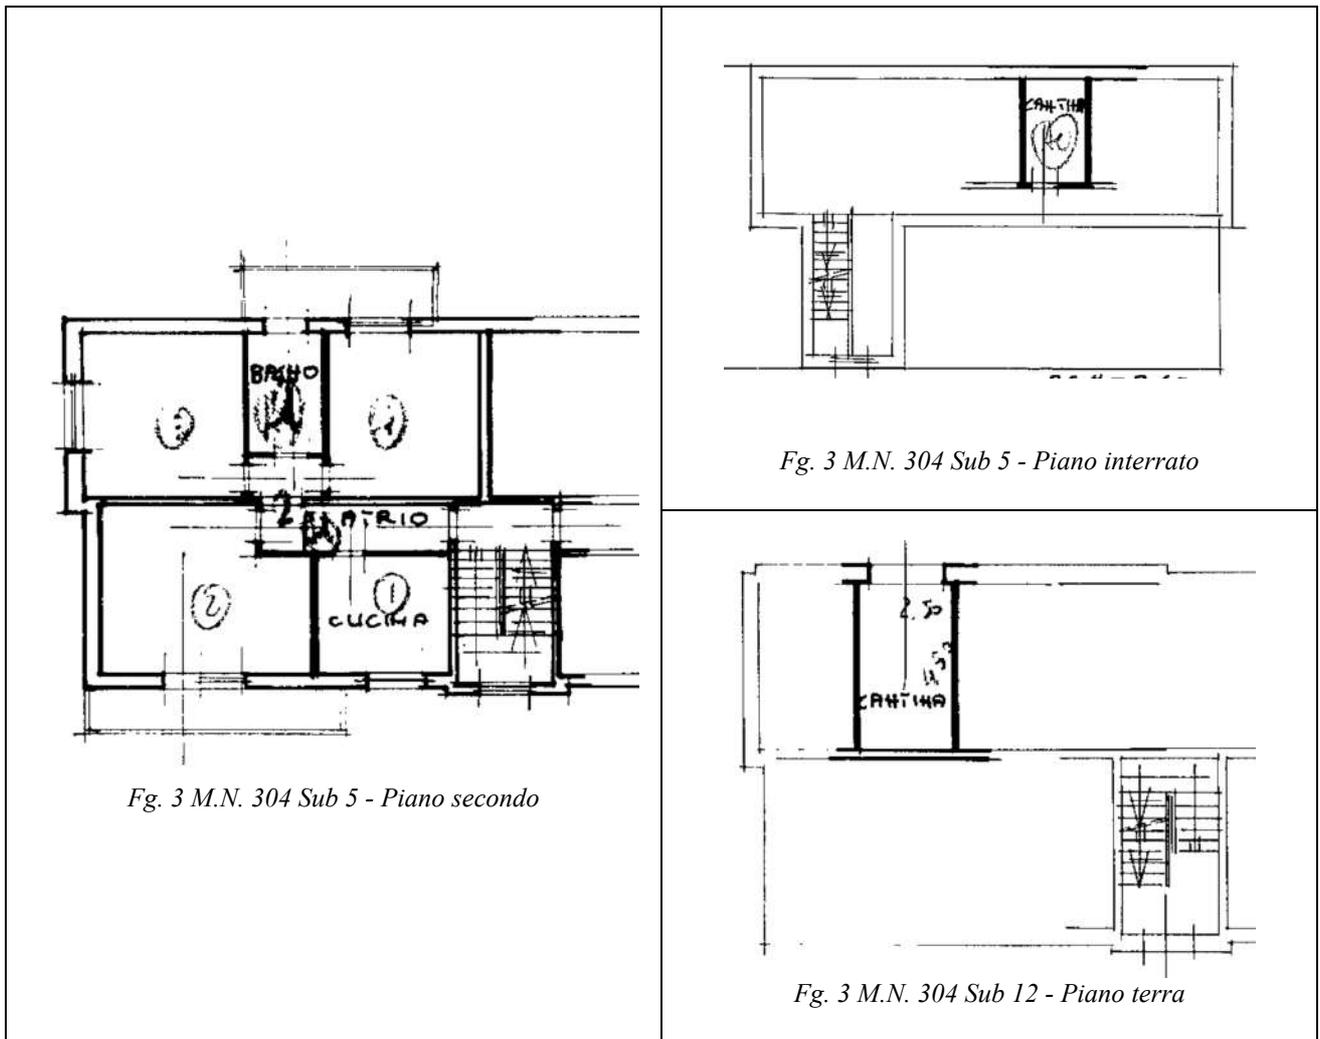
M.N. 304 Sub 5 - Piano secondo
